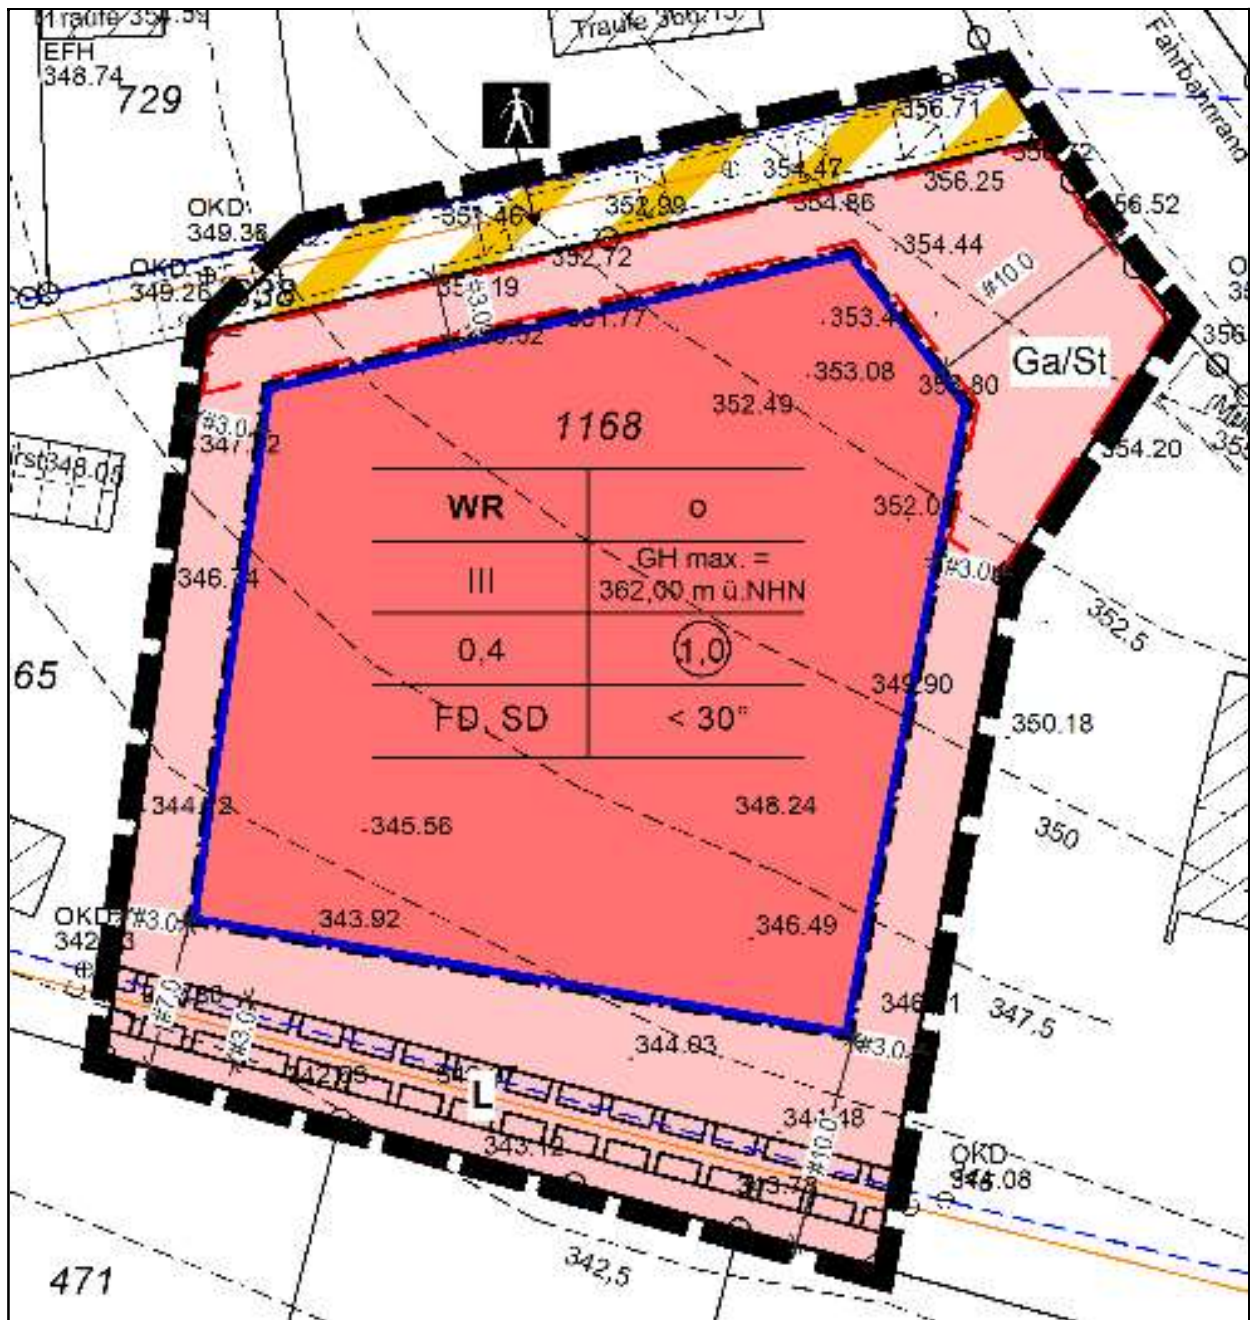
Bebauungsplan Nr. 6 „Obere Junge Ecke“, 14. Änderung, Entwurf ohne Maßstab
